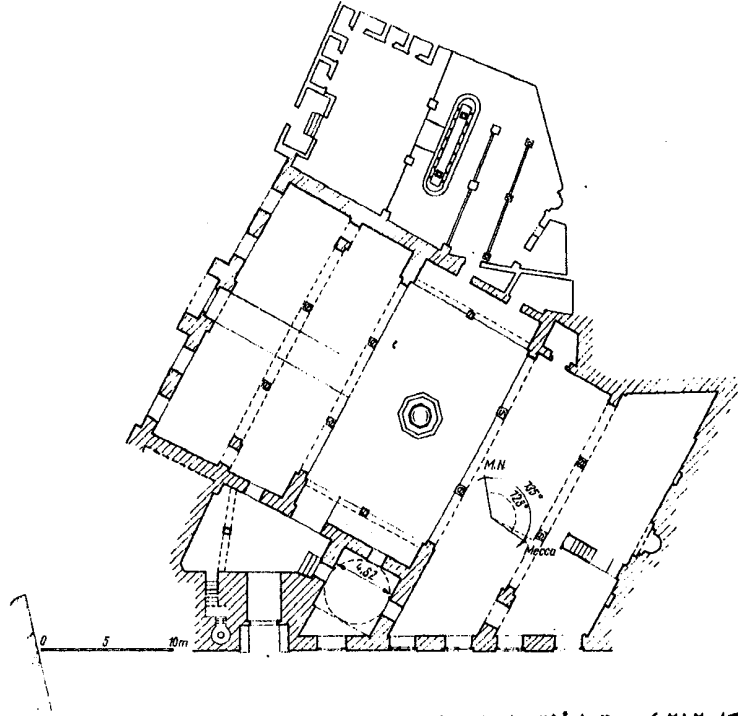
مسقط أفقي لجامع مراد باشا بالقاهرة .
